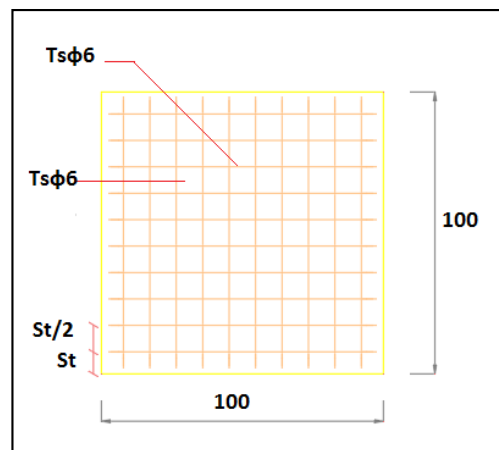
Disposition constructive des armatures de la dalle de compression.
